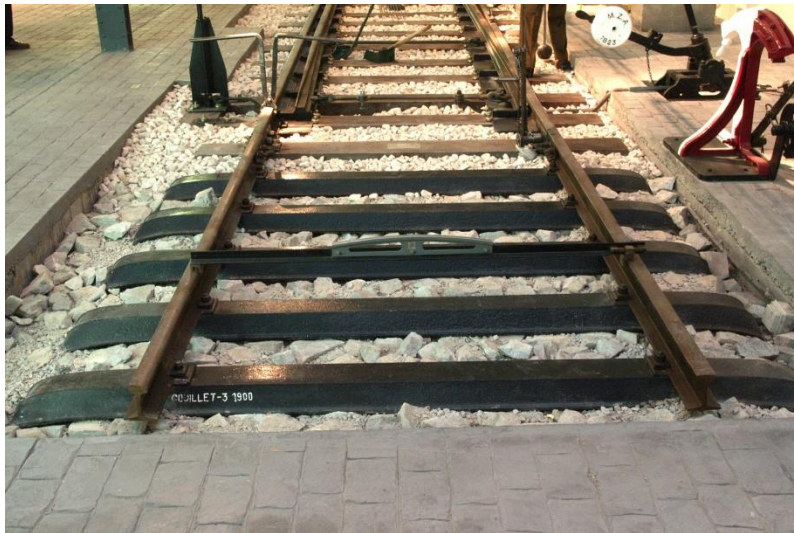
Traviesa Metálica. Fuente: Museo de Ferrocarril de Madrid
